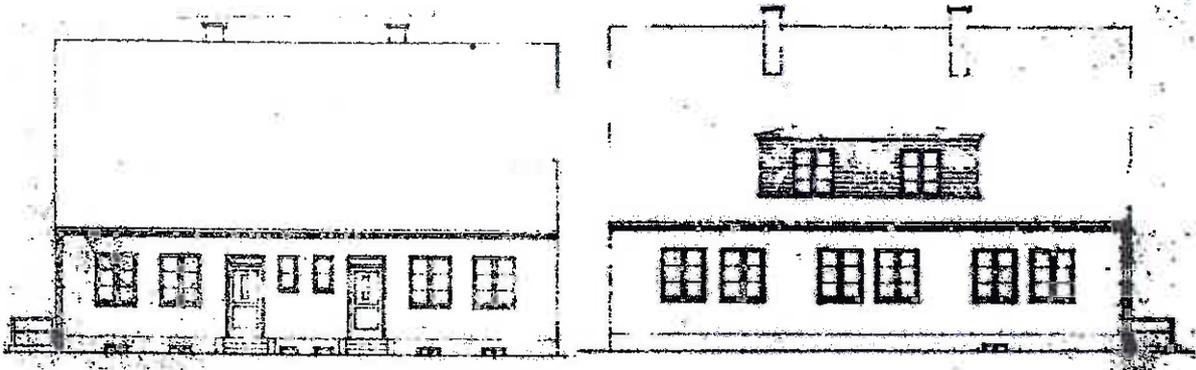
Ursprüngliche Vorder- und Rückansicht (Quelle: Stadt Eckernförde, Bauantragsunterlagen)
